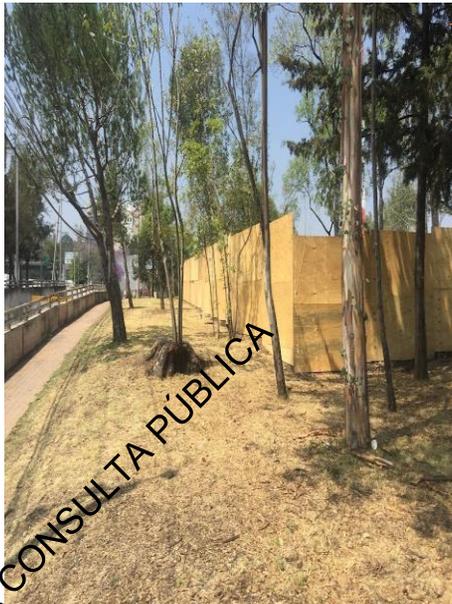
Vista poniente, se observa área verde y tapial de estación 3. (fecha de toma 29 03 2023)
